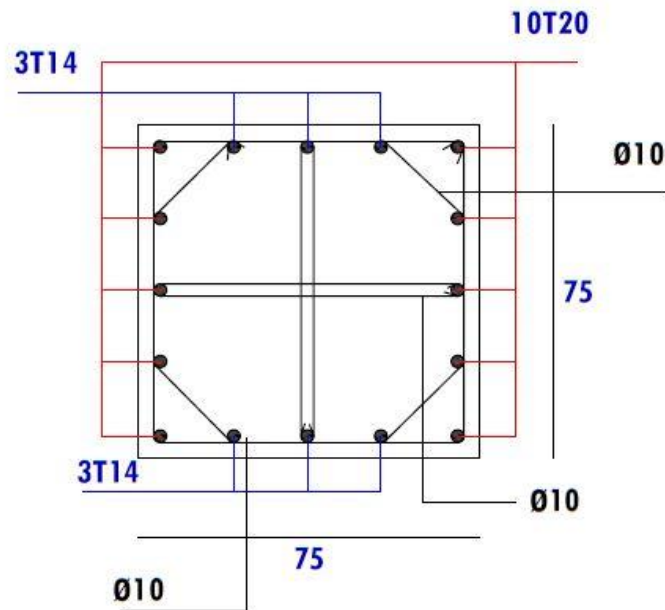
Schéma de ferrailage du poteau RDC (75×75) cm<sup>2</sup>
